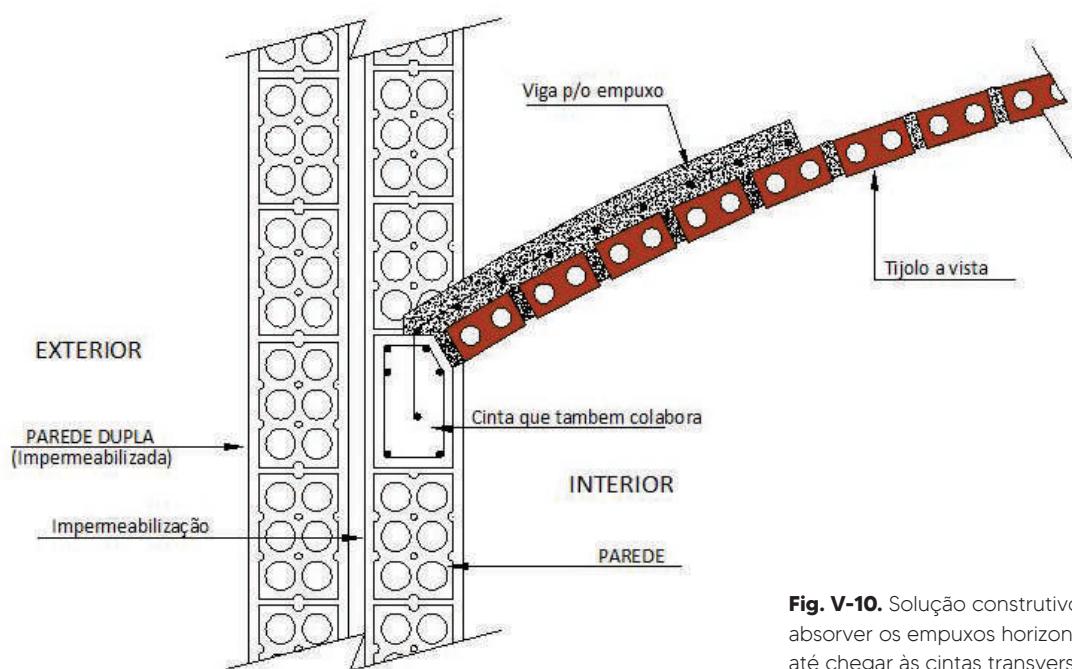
Solução construtivo-estrutural para absorver os empuxos horizontais das abóbadas até chegar às cintas transversais. (*-5).
